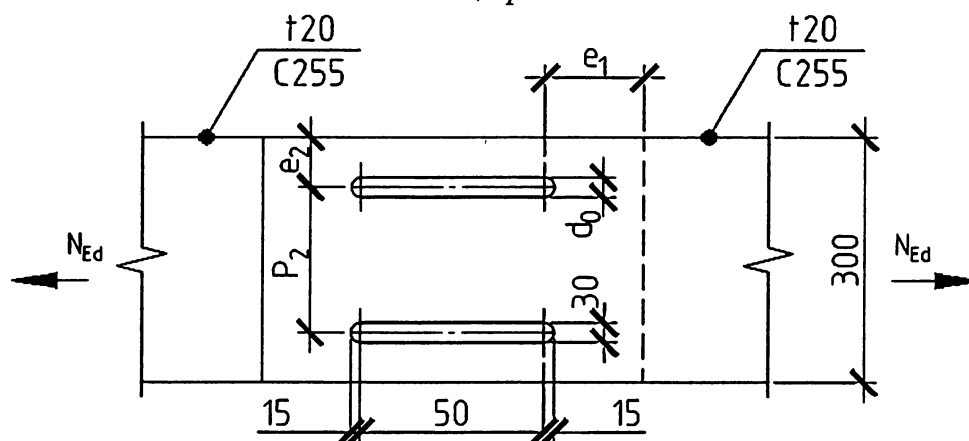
Сварное соединение двух полос внахлестку пробочными сварными швами
